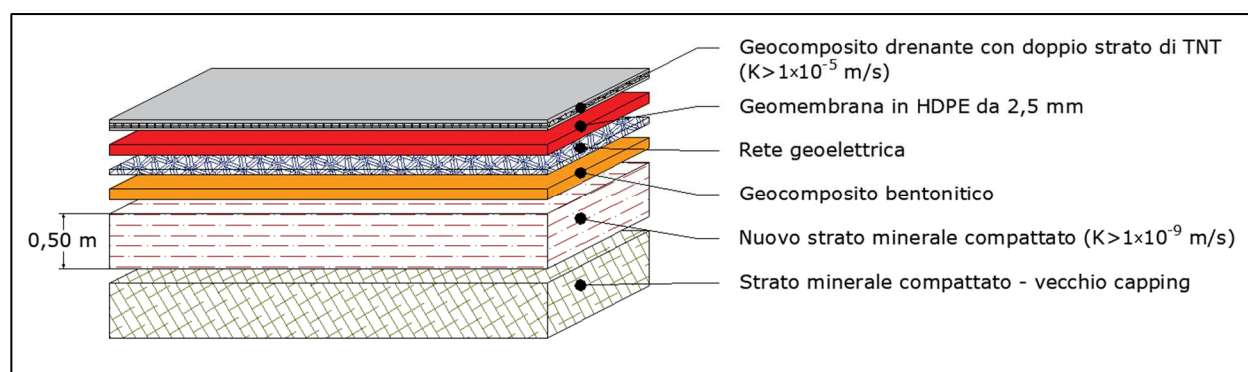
/XIX: Pacchetto impermeabilizzazione
